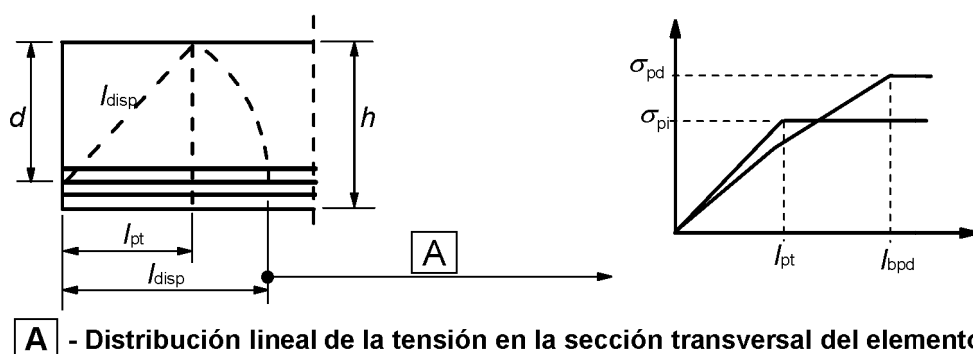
Transferencia del pretensado en elementos con armadura pretesa; parámetros de longitud
